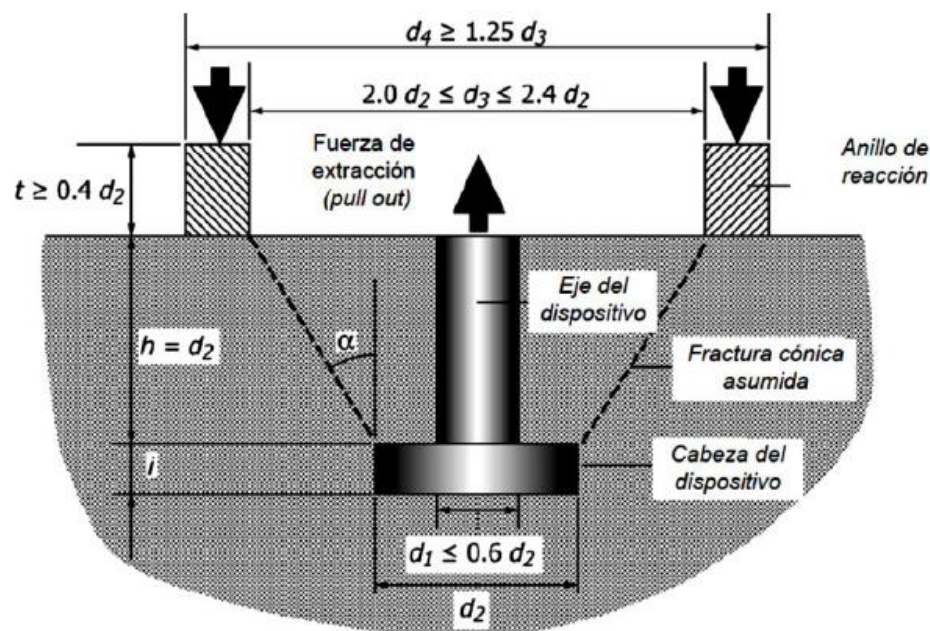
Esquema de la sección transversal del ensayo de extracción (Pull-Out) colado en obra
